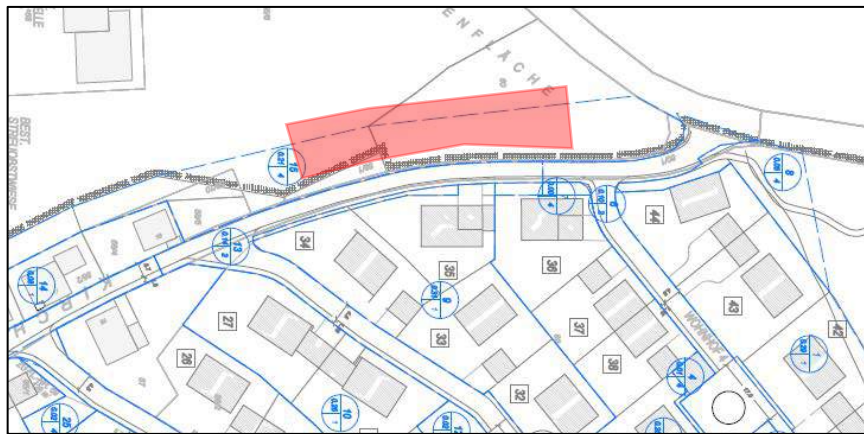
Berechnungsplan Regenwasserkanal – rote Fläche = BP Kirchenweg West
